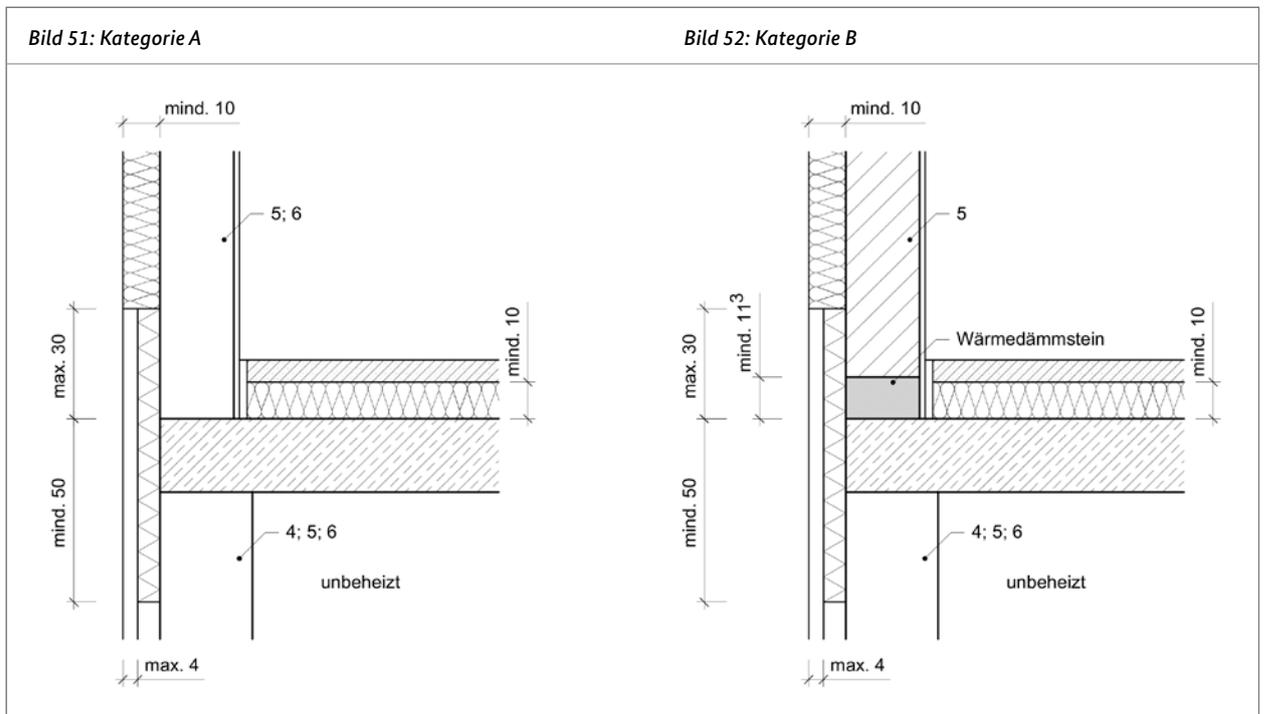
Planungsbeispiel für den Anschluss Außenwand an Kellerdecke (außengedämmte Konstruktion)
